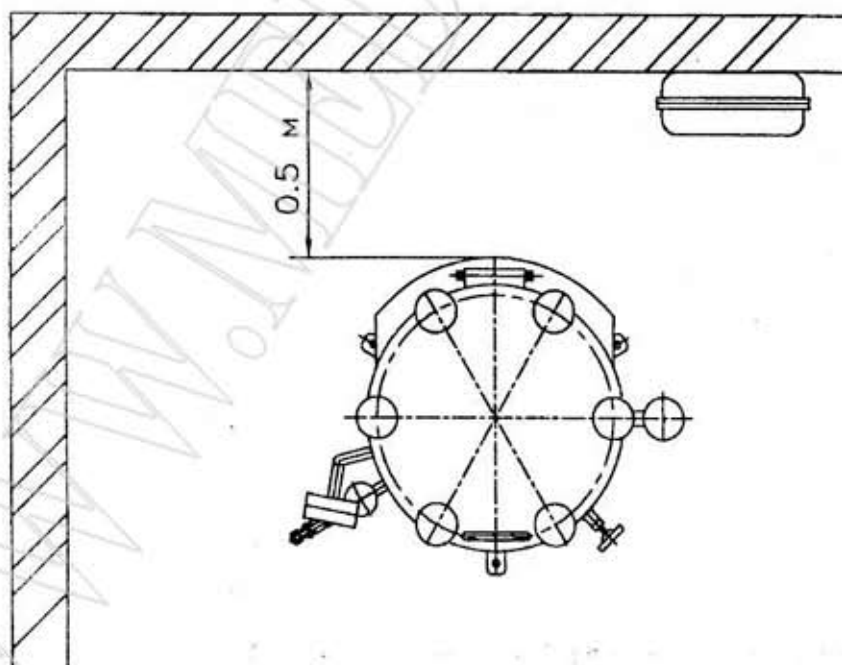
Установка стерилизатора парового ВК-75-01
